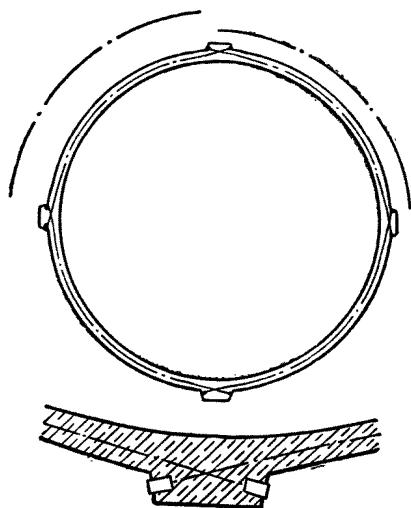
Схема расположения предварительно напряженной пучковой или стержневой арматуры в стенках резервуаров
